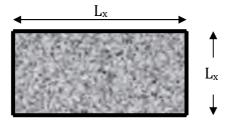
Exemple d'un panneau de dalle sur 4 appuis.
